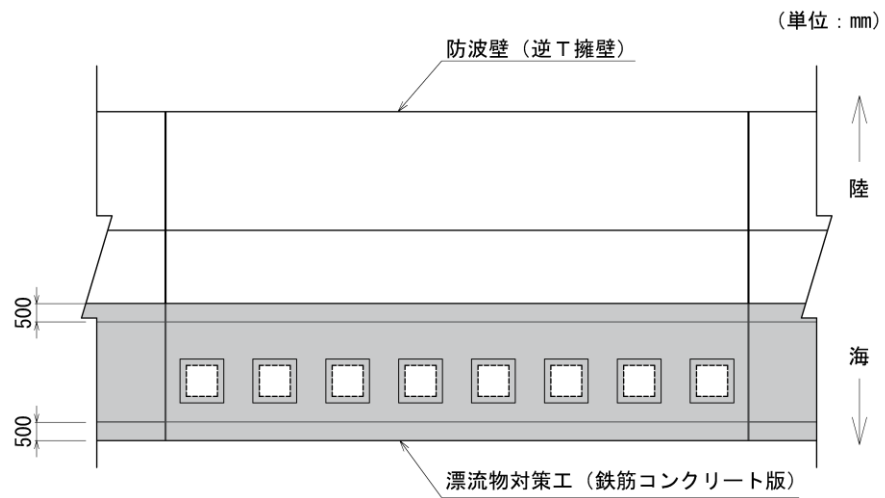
(1) 漂流物対策工 (鉄筋コンクリート版) の構造概要図 (平面図)
